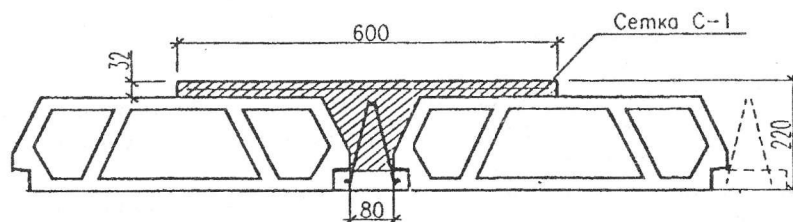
Фрагмент «нового» перекрытия типа «ДАХ-1а»
